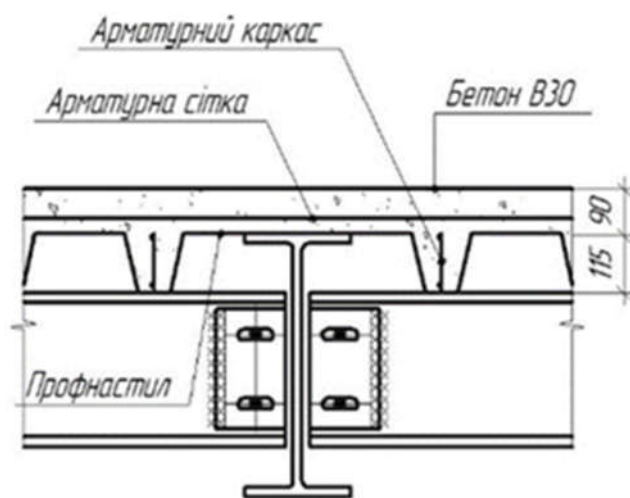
Поперечний переріз плити покриття вертолітного майданчика на даху будівлі
